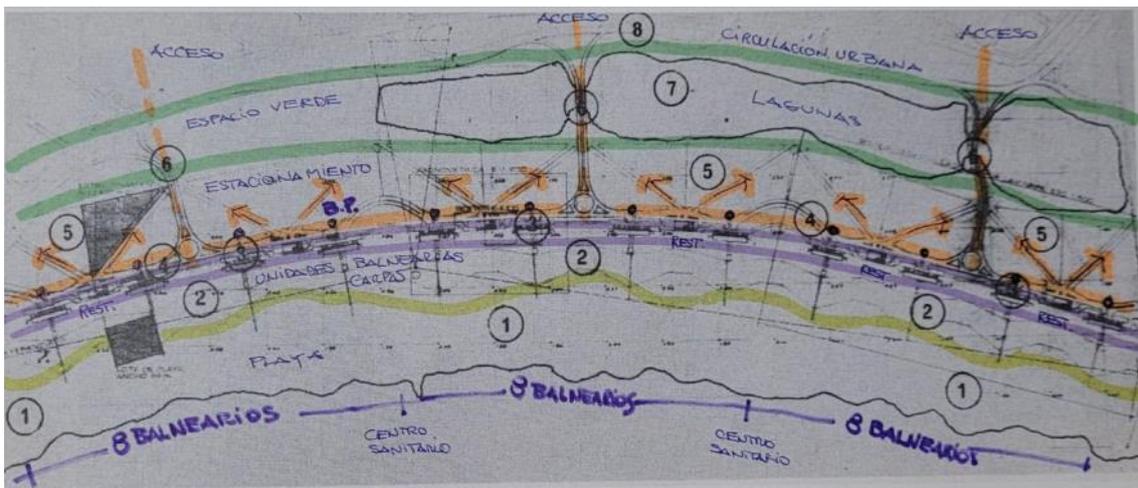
Plano de conjunto del Complejo balneario Punta Mogotes, primer proyecto (estudio Mariani). Elaboración propia sobre plano de Proyecto Punta Mogotes.
